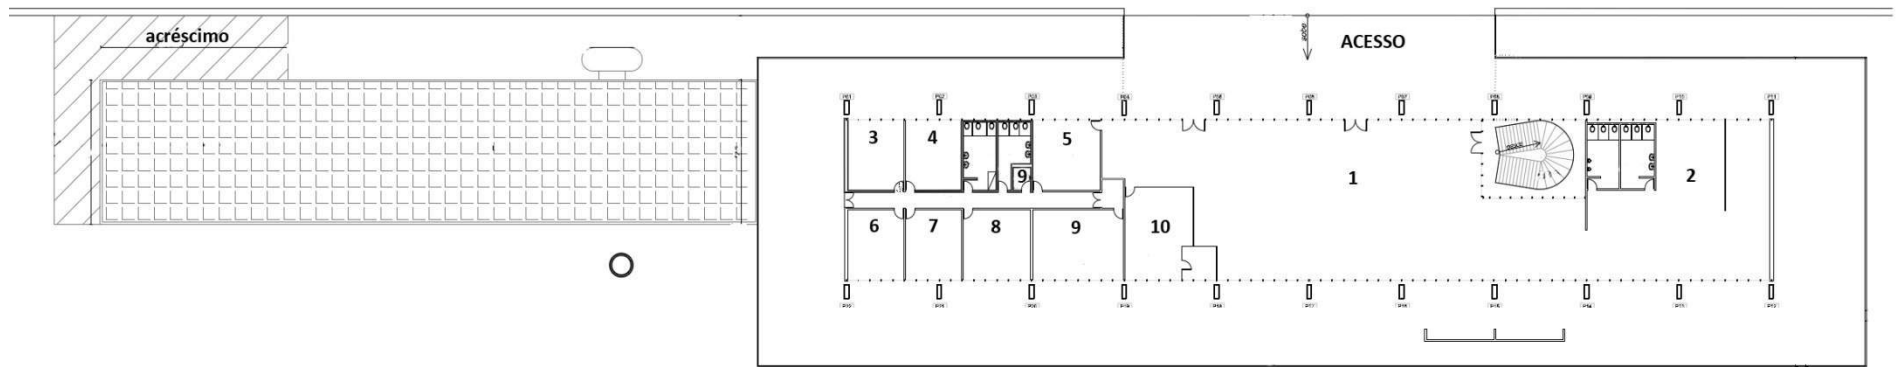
Planta do Piso superior. Fonte: ALBERNAZ, 2012.
